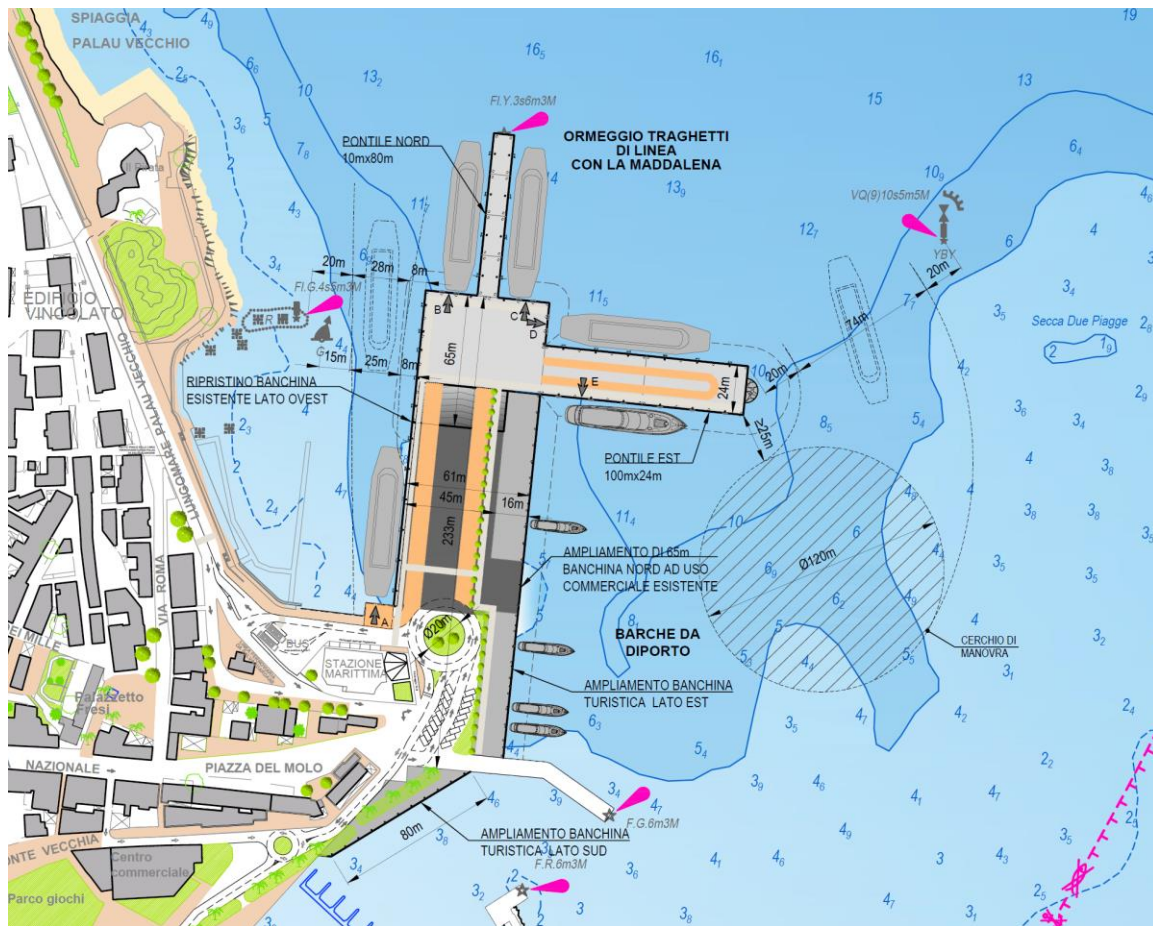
Ipotesi di "Assetto finale": Planimetria generale
